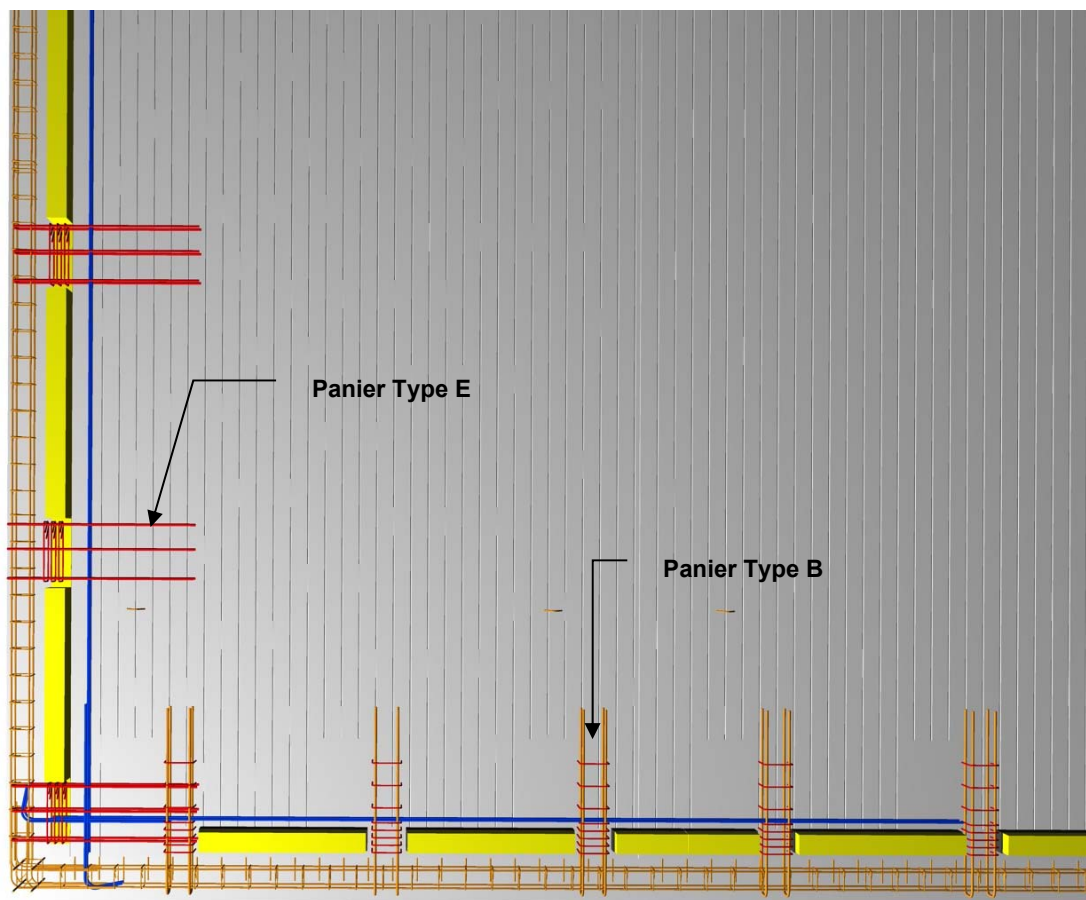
Vue en plan – Exemple avec paniers type E et B
